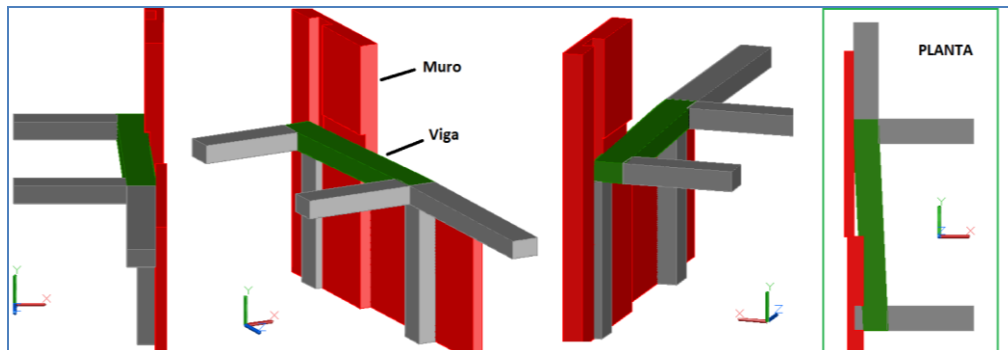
Esquema de la modificación efectuada en la posición de la viga V1Y en su arribo a la columna C1.
